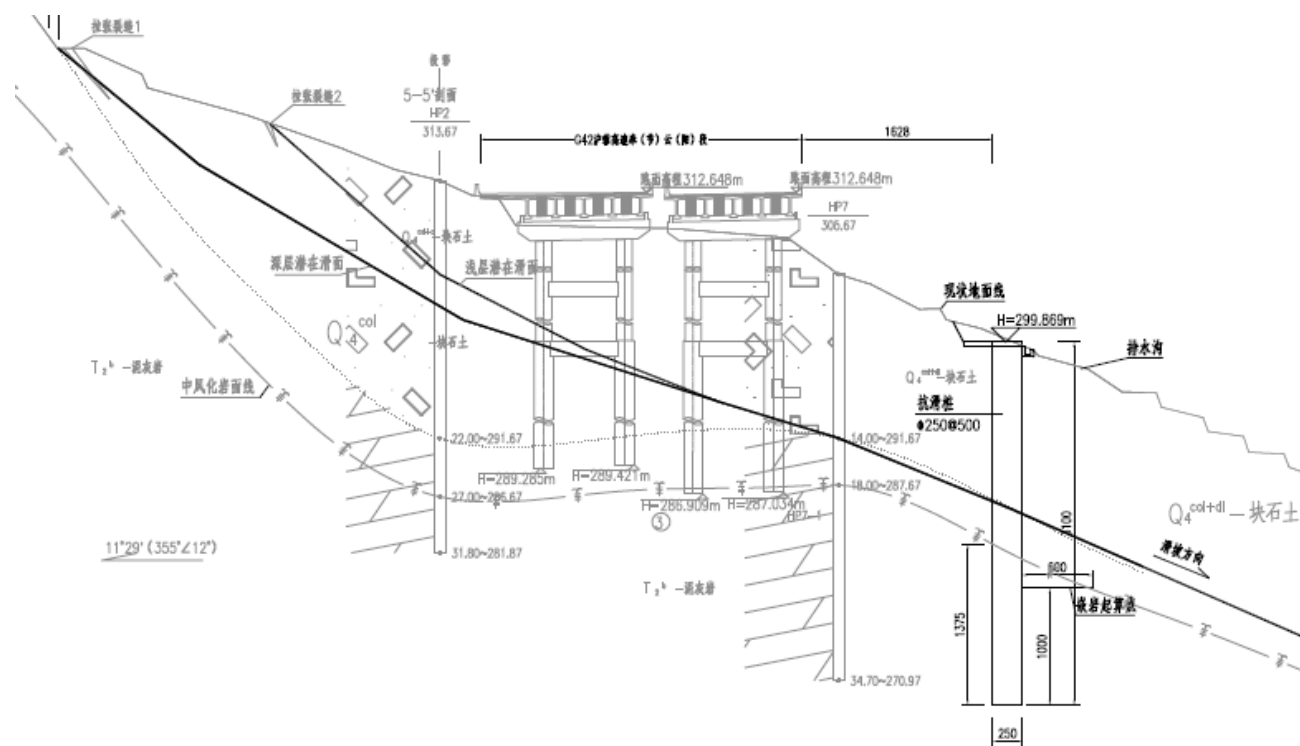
左幅 3#墩断面边坡处治布置图 (单位: cm)
